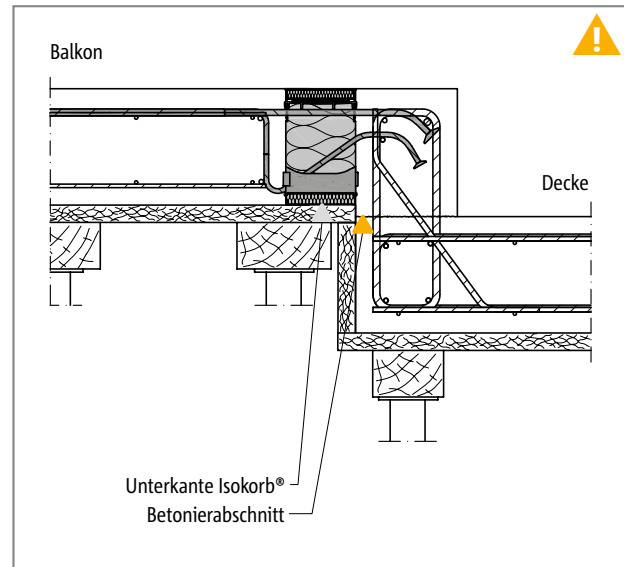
Schöck Isokorb® XT Typ K-O: Ortbetonbalkon mit Höhenversatz nach oben
